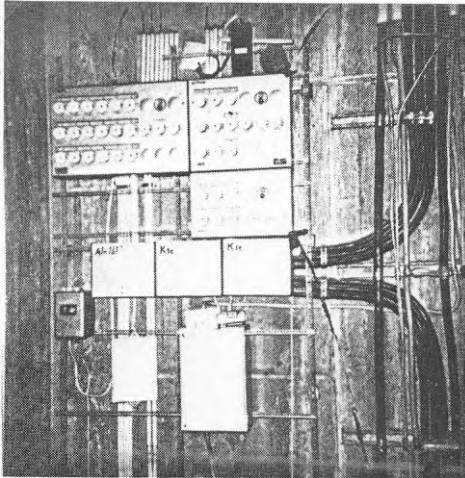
Elcentral, blå flygel, plan 10.
